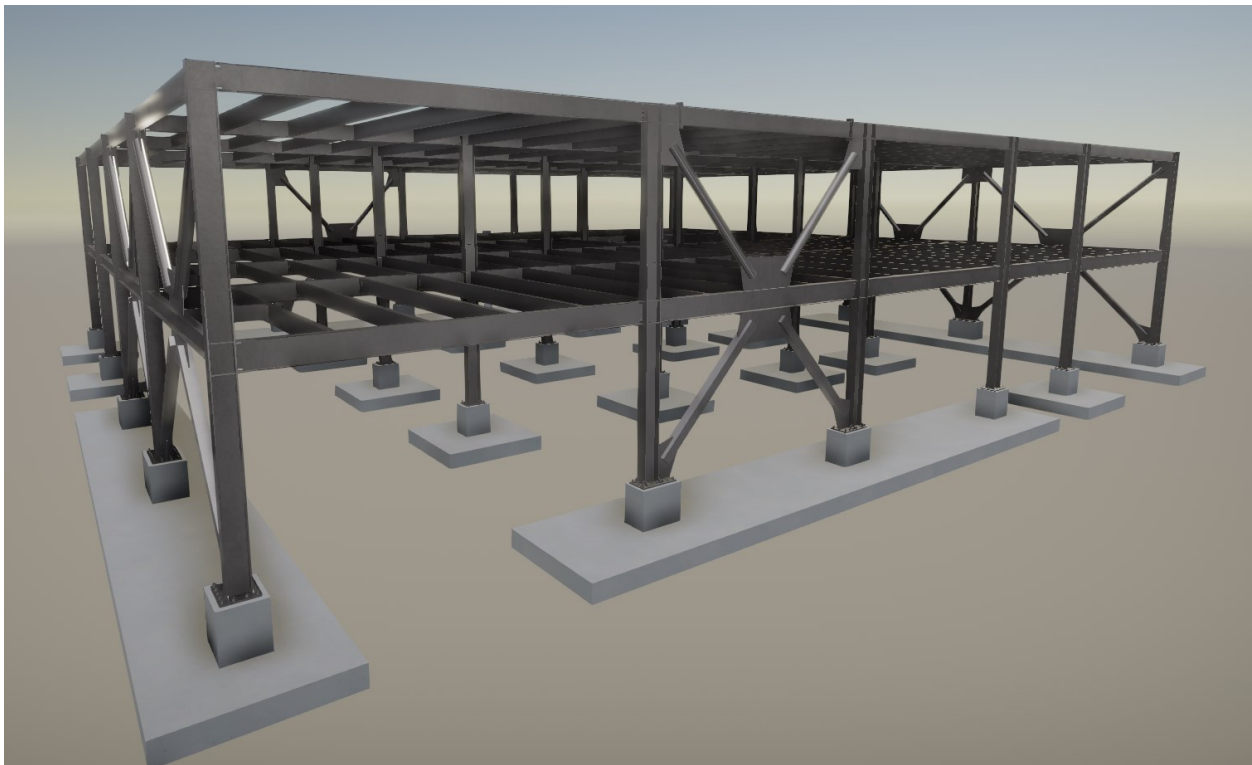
Modelo BIM. Proyecto renderizado en Tekla Structures.
